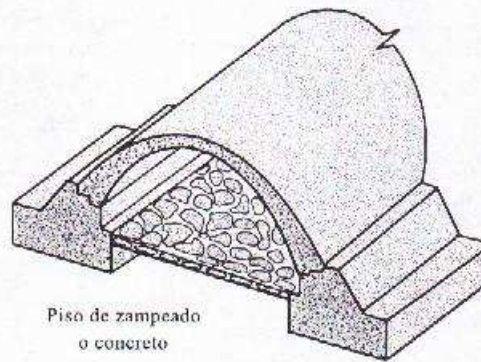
Alcantarilla con muros sencillos y gabacha.
